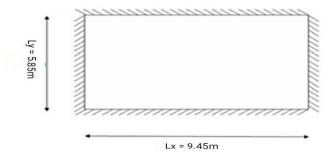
Dimensions du panneau le plus défavorable.
